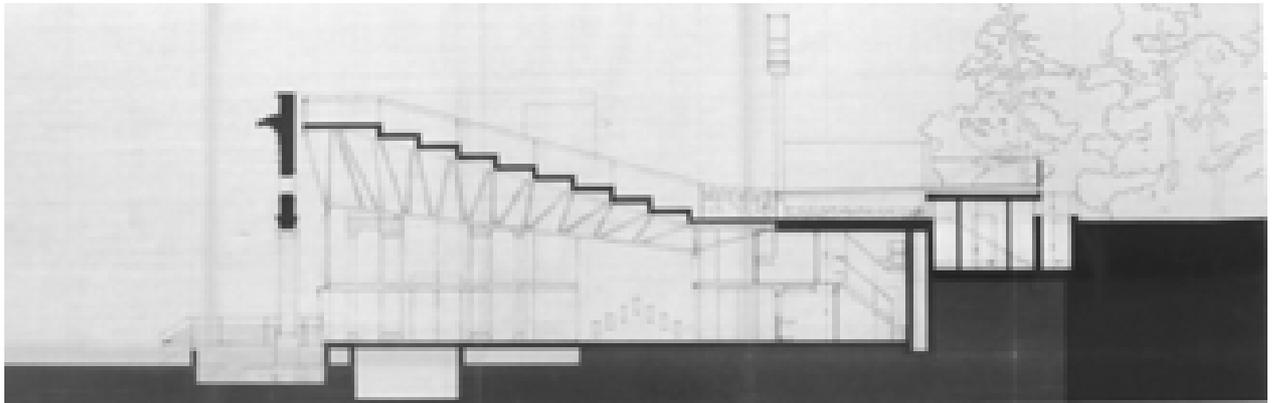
Sezione XX, stato futuro – opere di completamento – 11/06/1997 (AABS-640)
